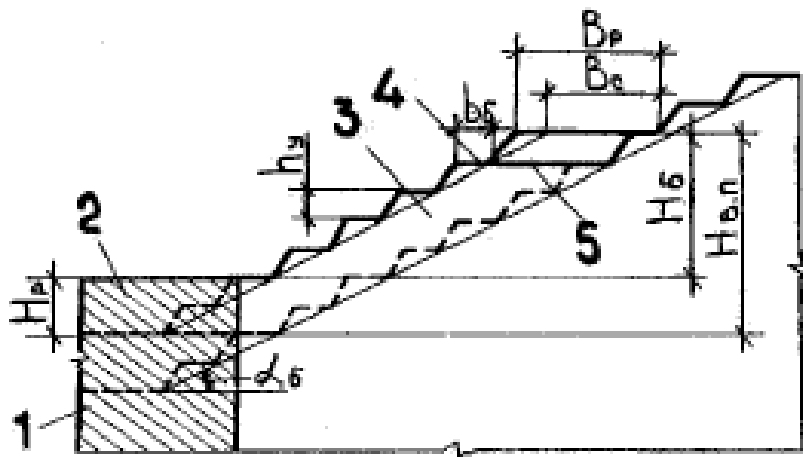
Конструкція робочого борту кар'єра: 1 – поклад корисної копалини; 2 – зона поглиблення; 3 – крутонахилений шар; 4 – тимчасово неробоча площадка; 5 – робоча площадка
